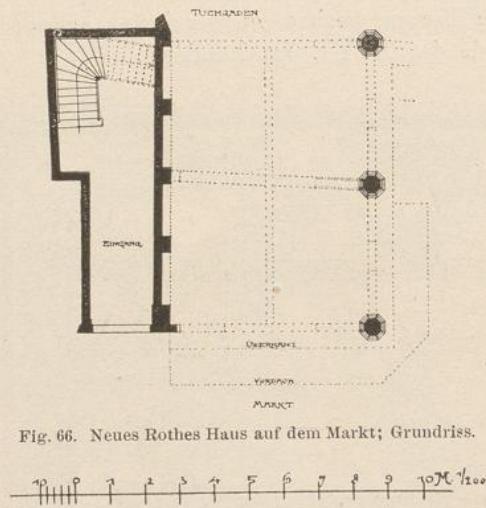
Neues Rothes Haus auf dem Markt; Grundriss.
